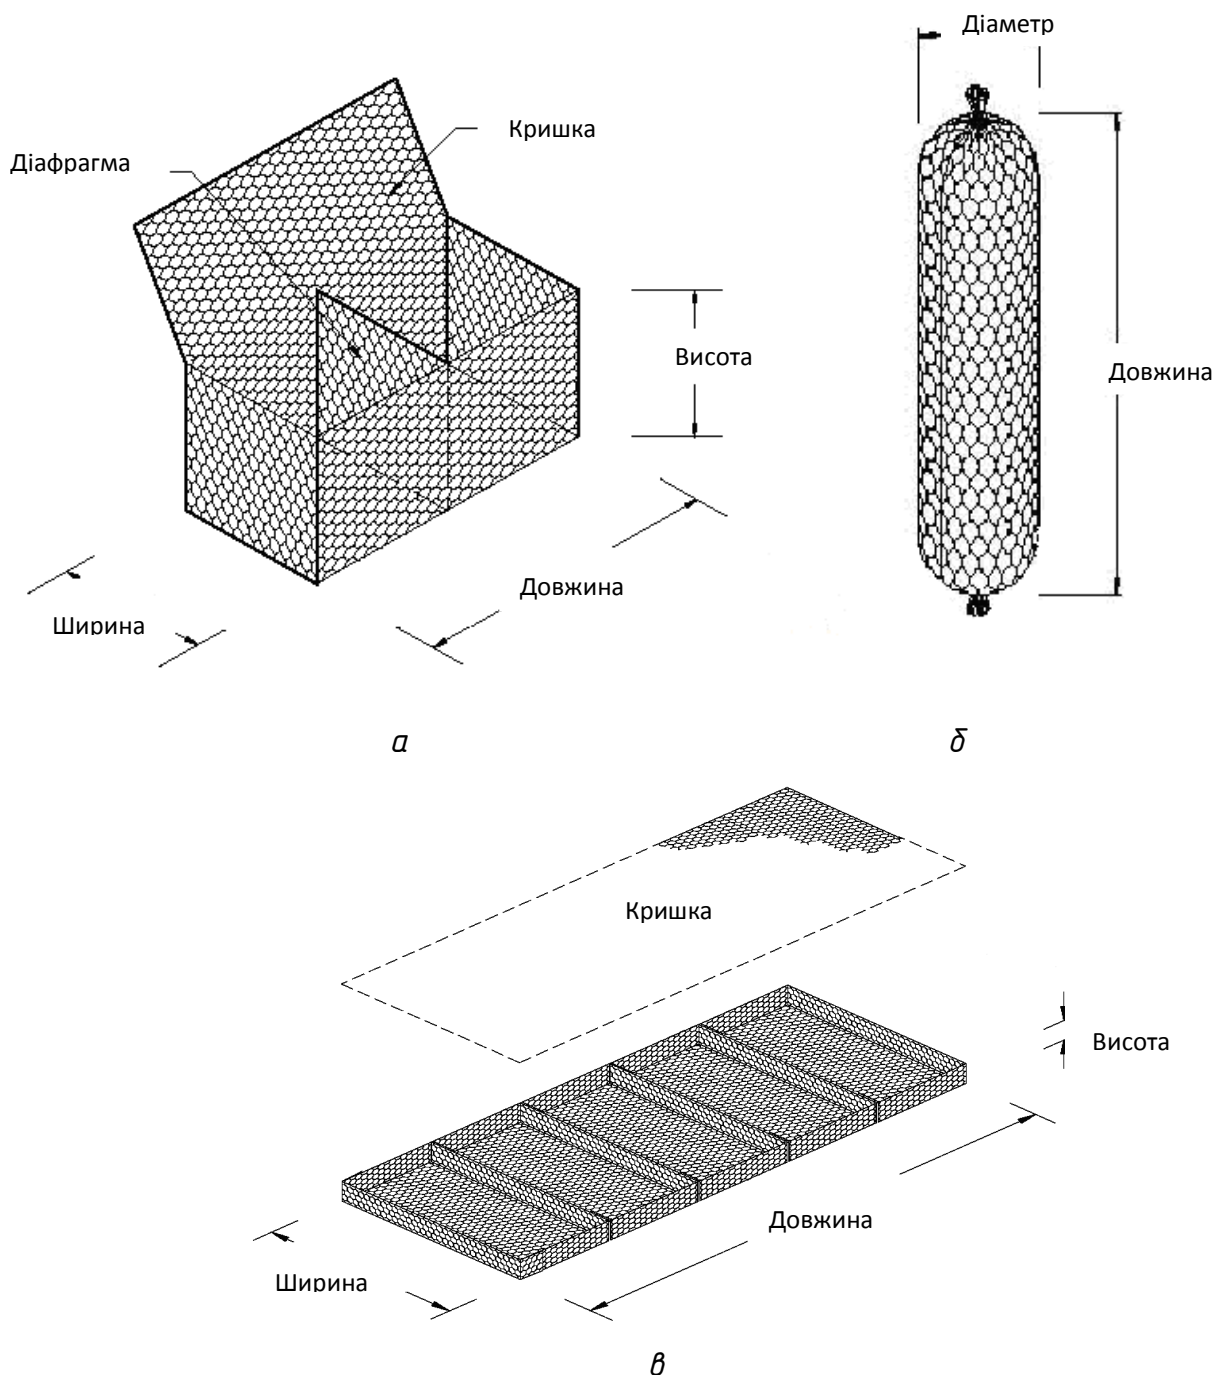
Типи габіонових конструкцій: а – коробчаті; б – циліндричні, в – матрацні.
